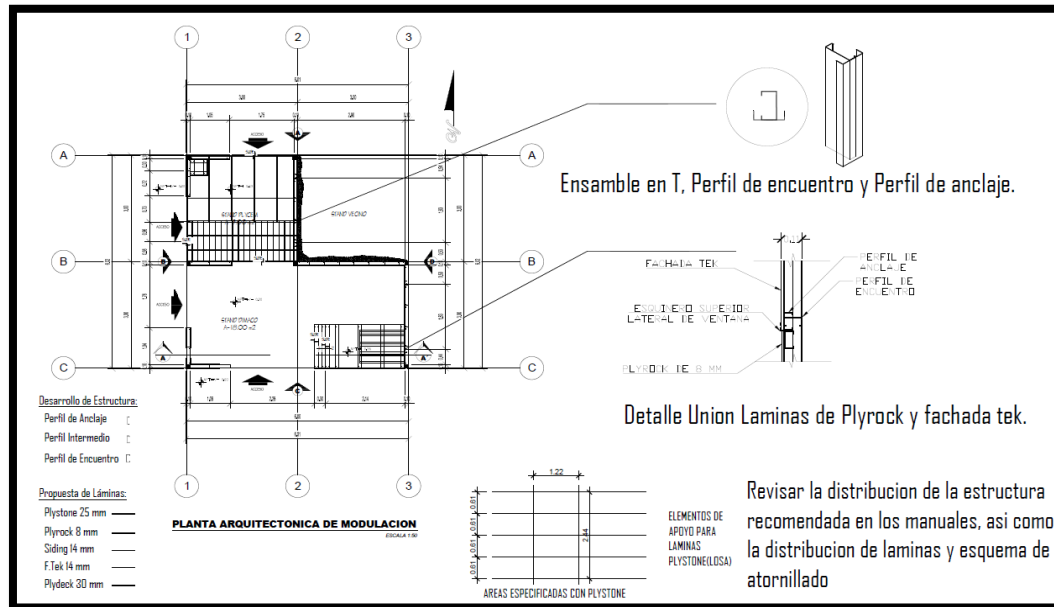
Planta arquitectónica de stand FERCON 2014. Fuente: propia (2014).
